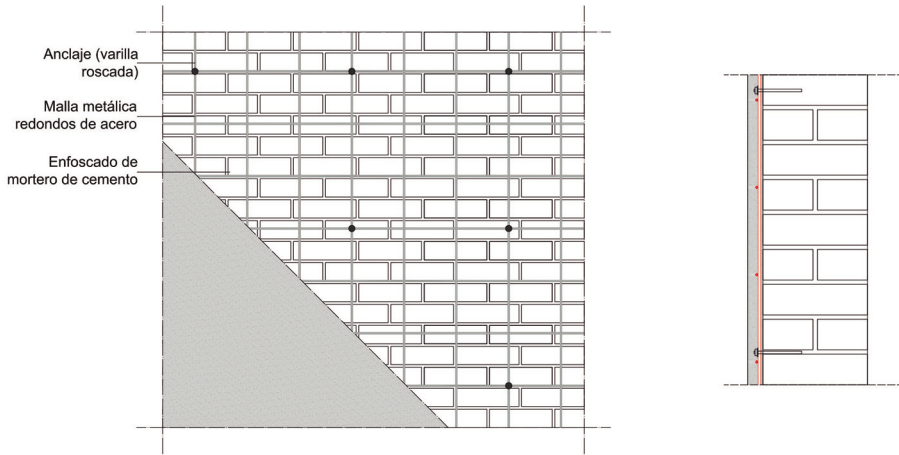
Malla de redondos de acero cubierta por hormigón proyectado. Esquema y detalle constructivo.
